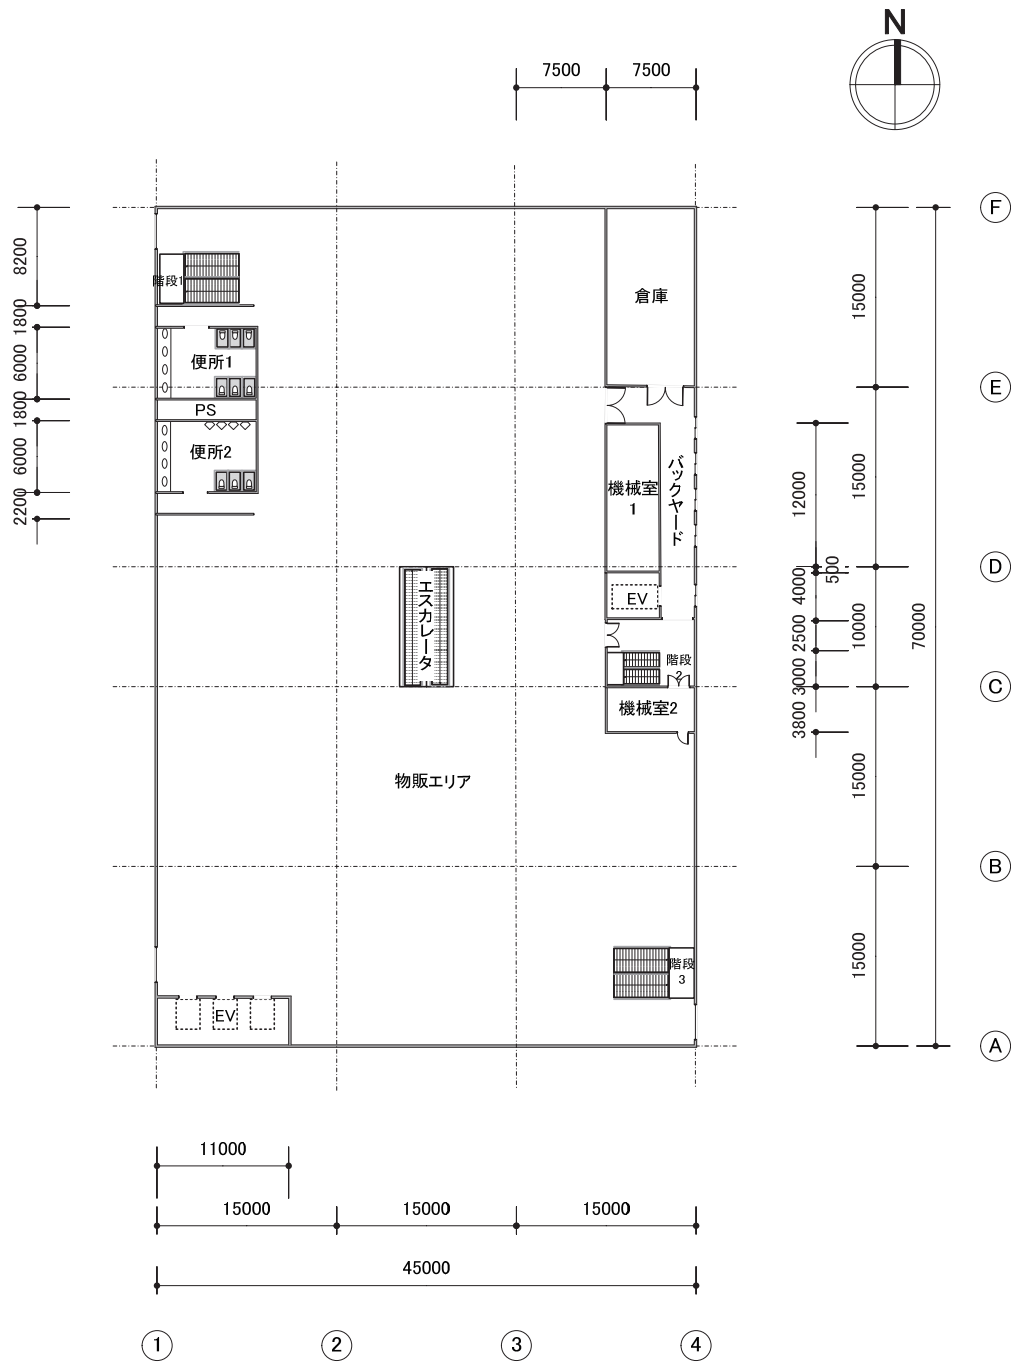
A.17 モデル建物（物販店舗等、10,000㎡） 2～3階平面図
